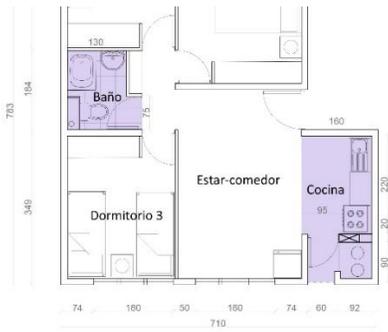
Cocina tipología 1 Lo Ermita. Fuente: Elaboración propia
